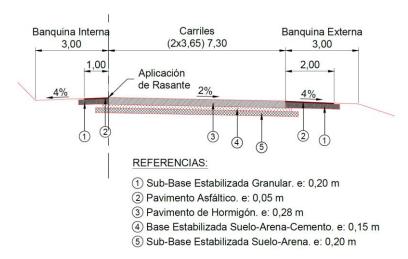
Perfil tipo ramales de 7,30 metros de ancho.
